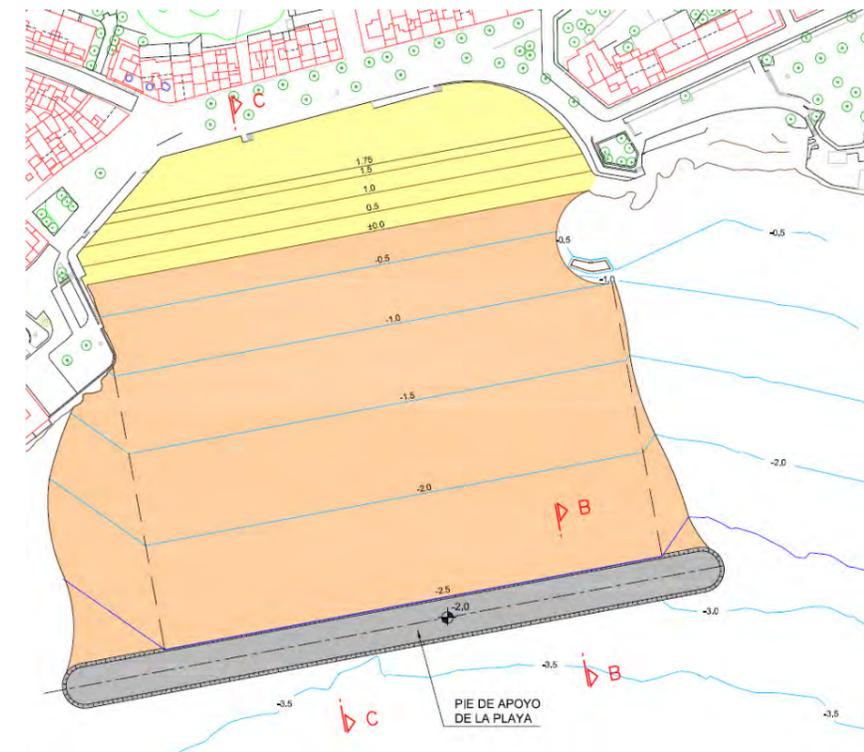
Planta de la Alternativa 1. (Fuente: Elaboración propia)
